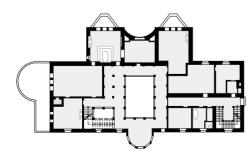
Grundriss 1. Obergeschoß.
